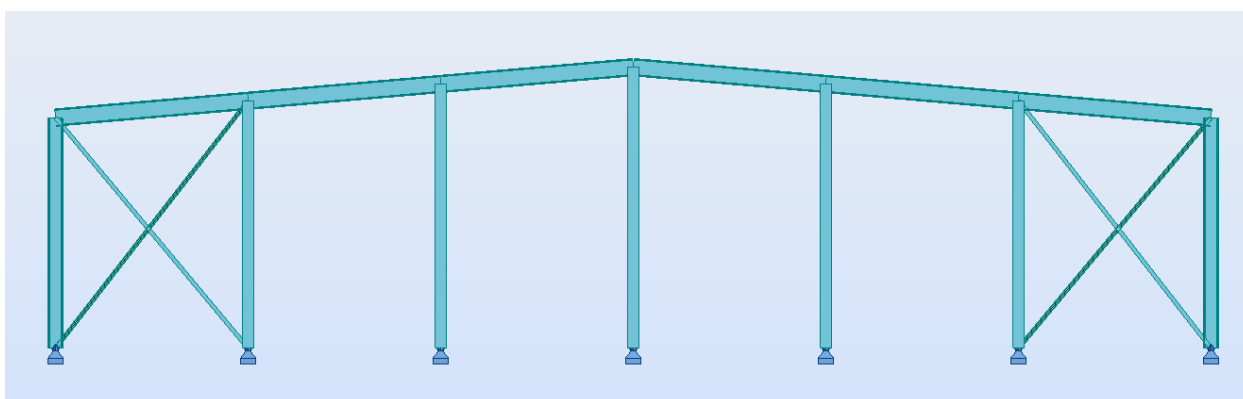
Modelação do pórtico tipo 2 (pórtico de fachada)
